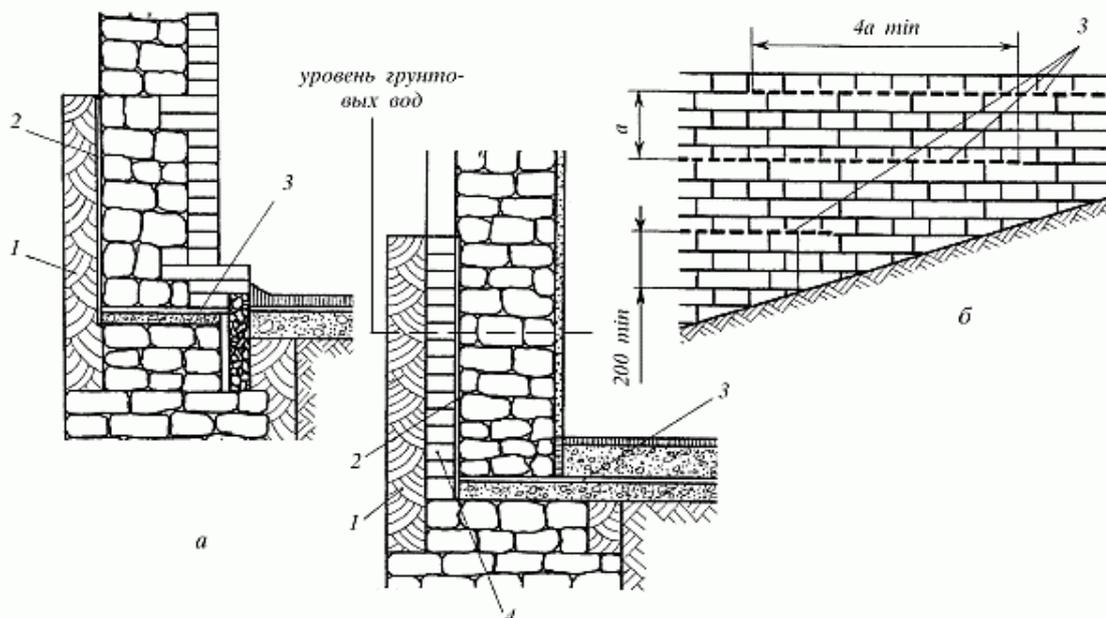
Гидроизоляция фундаментов: а – вертикальная; б – горизонтальная; 1 – глиняный замок; 2 – оклеечная изоляция; 3 – горизонтальная изоляция; 4 – прижимная стенка
